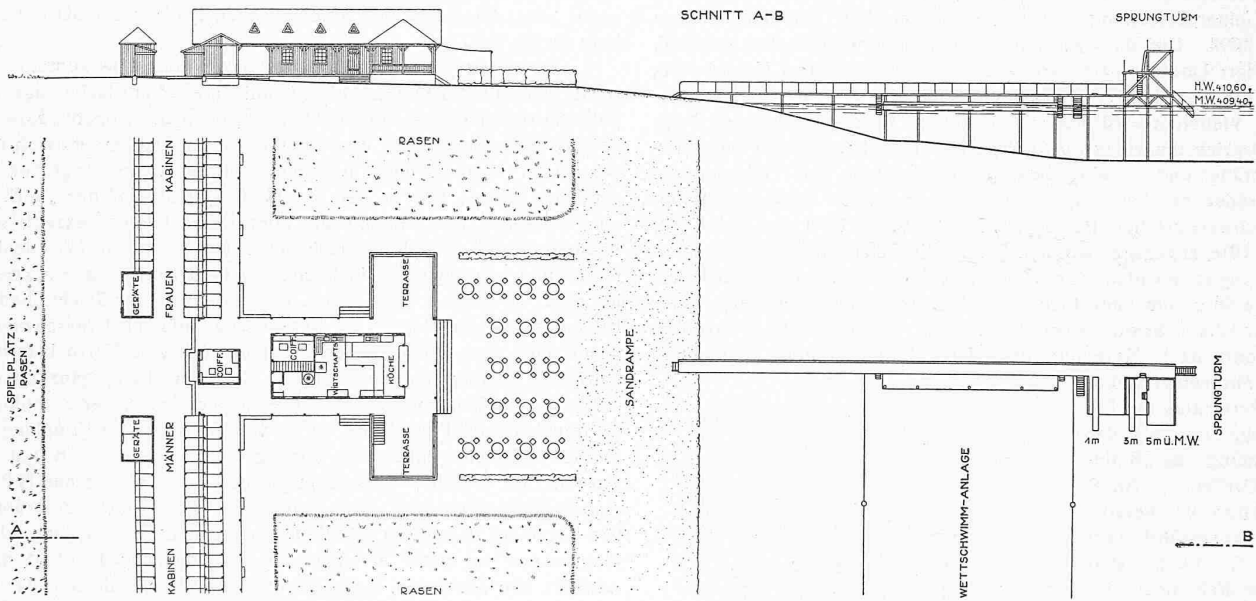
Mittelpartie des erweiterte Zürcher Strandbades. — Grundriss und Schnitt A-B, 1 : 600.
